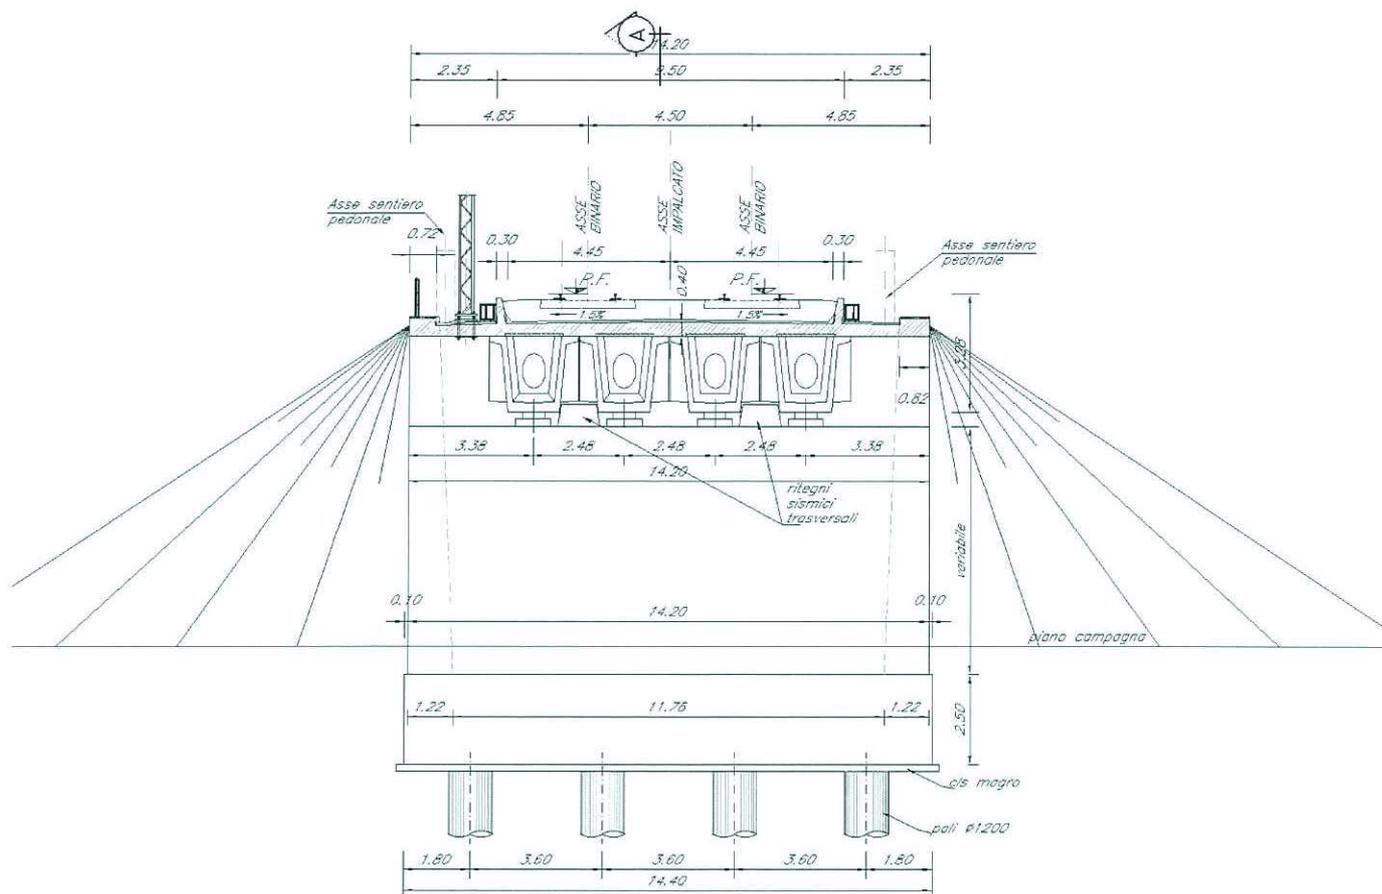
Sezione trasversale in asse appoggi della spalla tipo.
